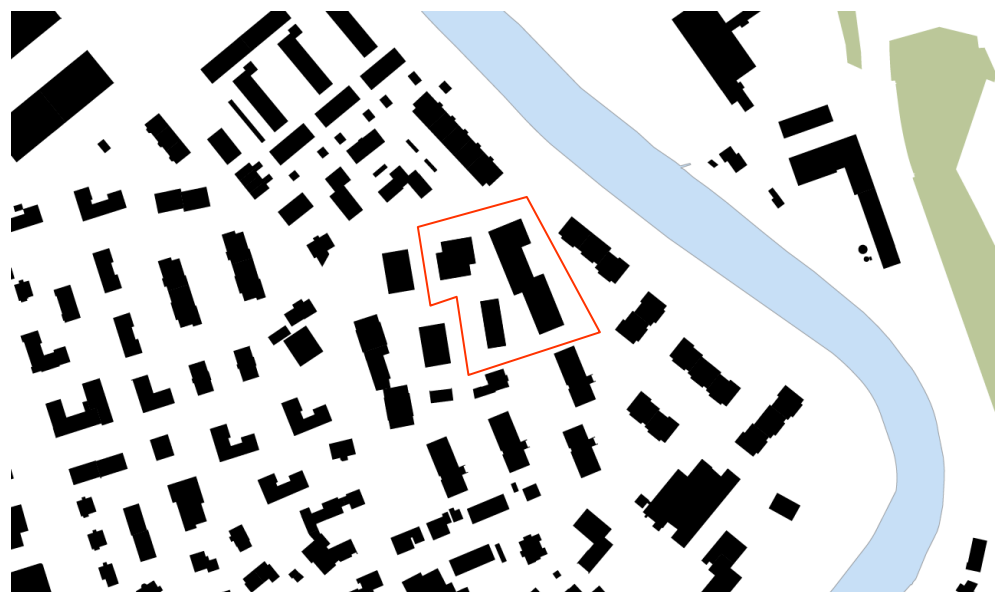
Schwarzplan mit Planungsperimeter (rot)
